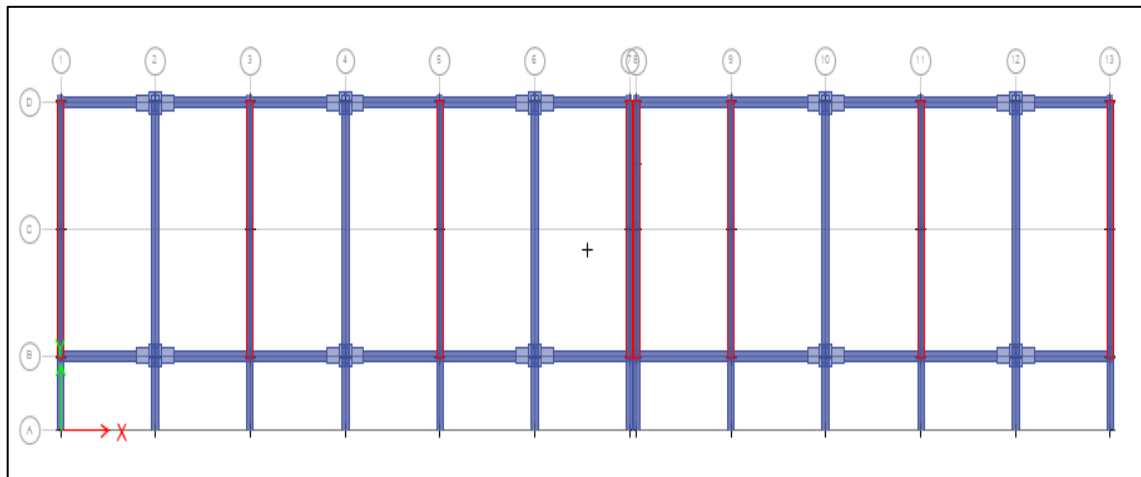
Plano en planta reforzado las columnas, pabellón 1
